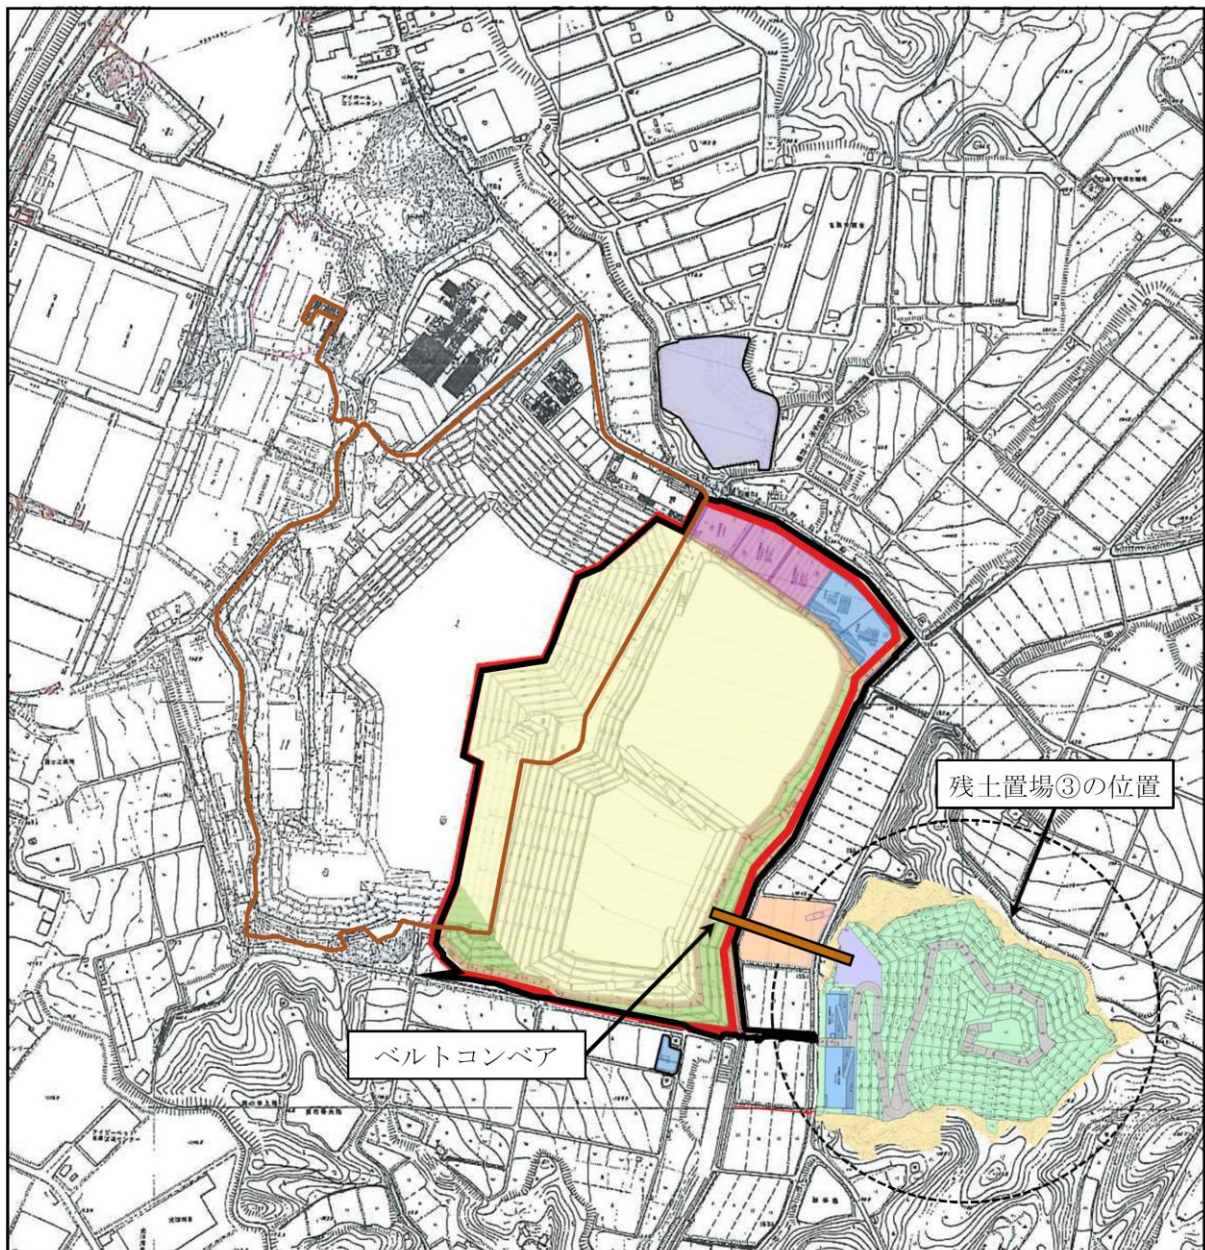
(1) 土地利用計画平面図(第2期工事:埋立中) <変更前>
